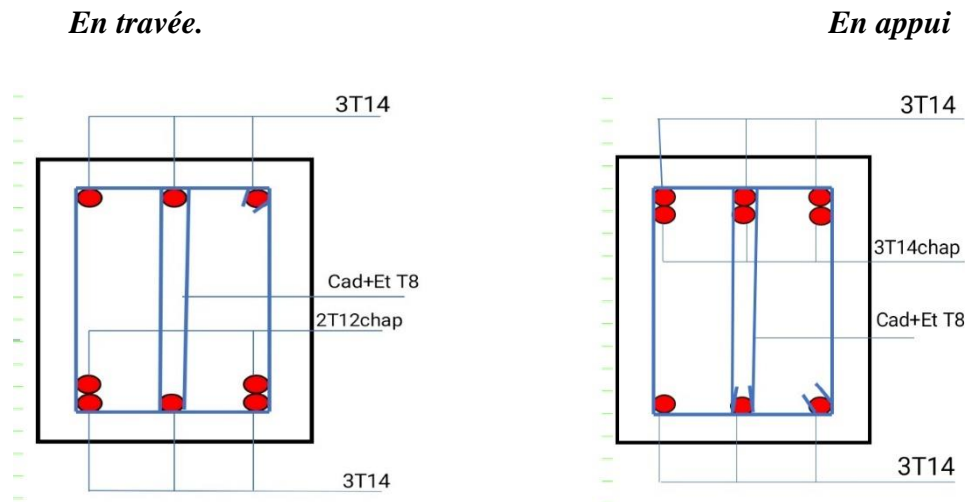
3: Schémas des ferrailages des poutres secondaires
